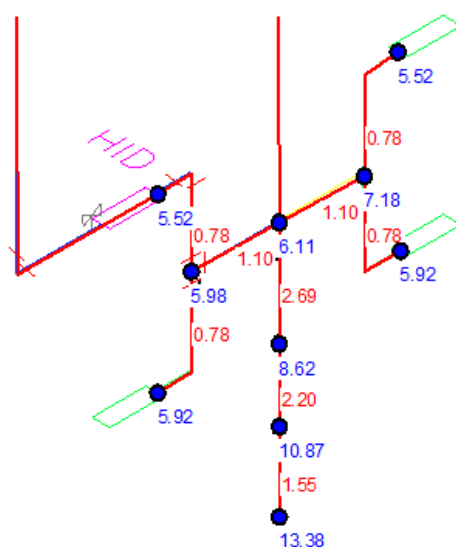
Dimensões e pressões nos pavimentos inferiores
